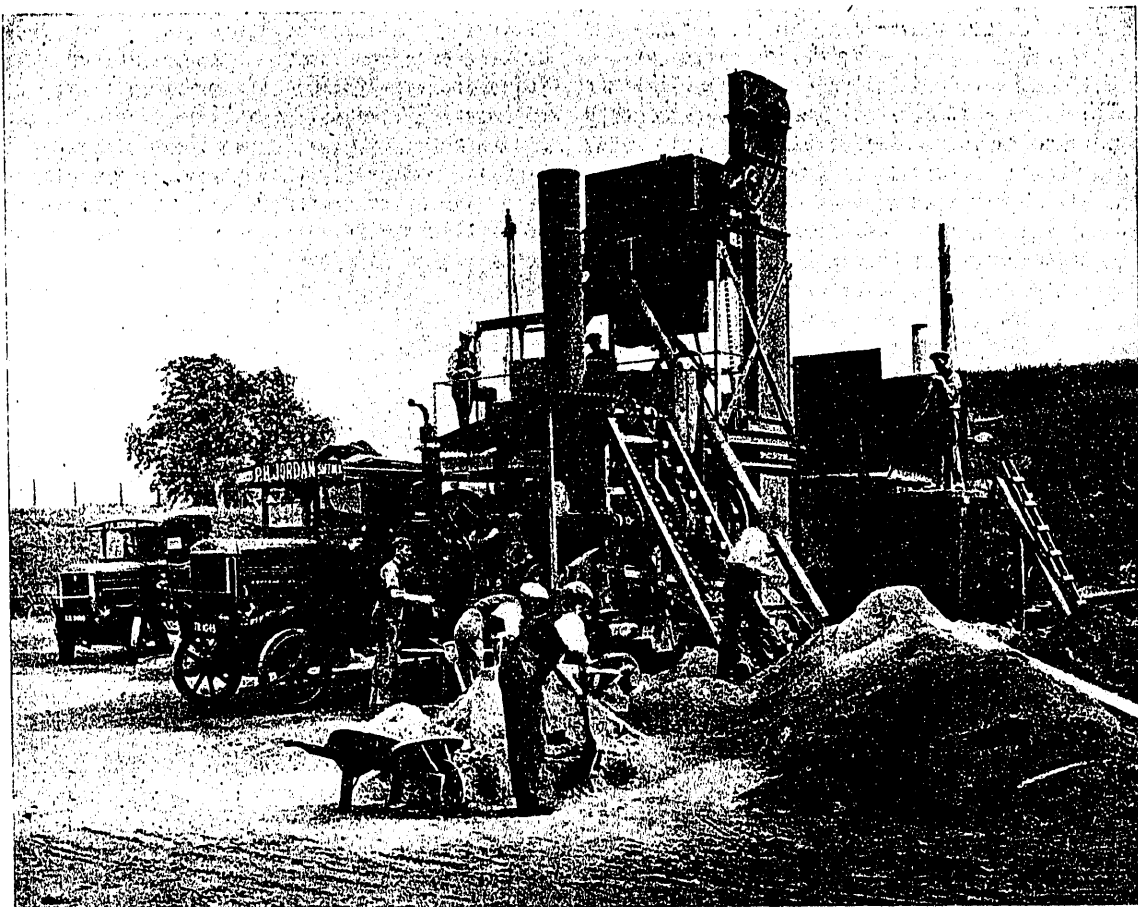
Taller portátil para la fabricación del hormigón asfáltico
